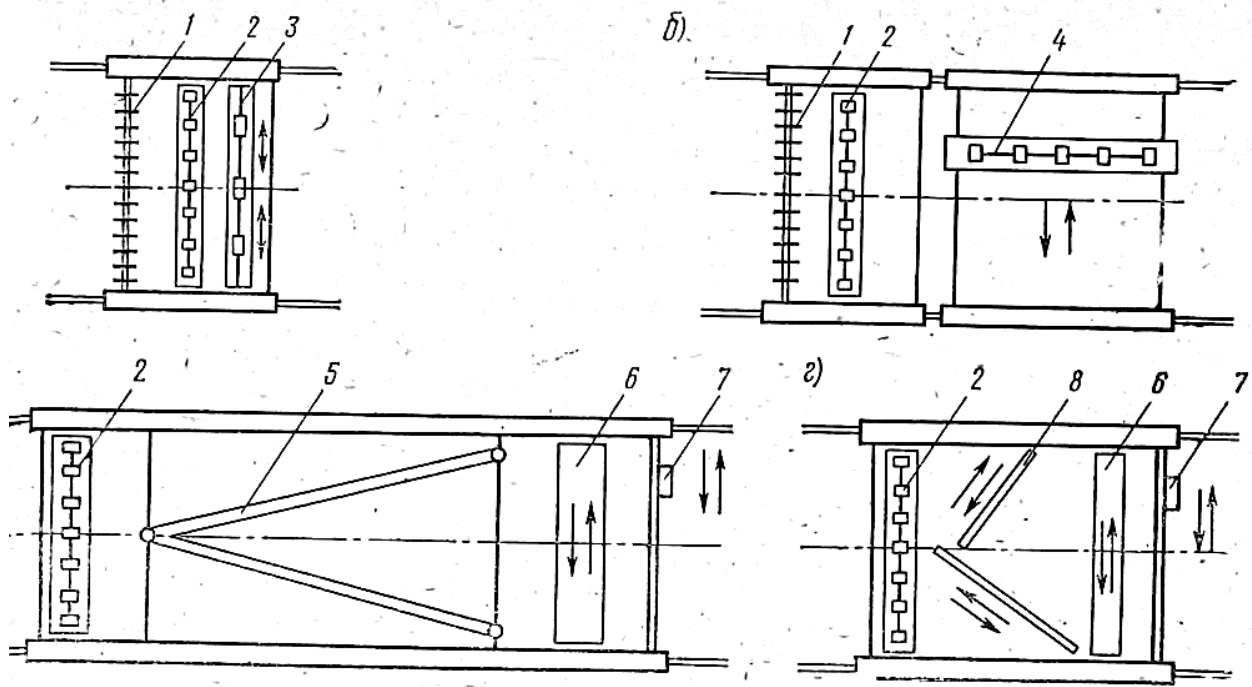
Компонувальні схеми рейкових бетонооздоблювальних машин: а – короткобазова; б – комбінована; в – довгобазова багатоопорна; г – довгобазова. Робочі органи: 1 – лопатевий вал; 2 – вібраційний ущільнювальний брус; 3 – вирівнювальний вібраційний брус; 4 – поздовжній вібраційний брус; 5 – діагональний вирівнювальний брус; 6 – поперечний вигладжувальний брус; 7 – щітка; 8 – діагональні качаючі вібробриси.
